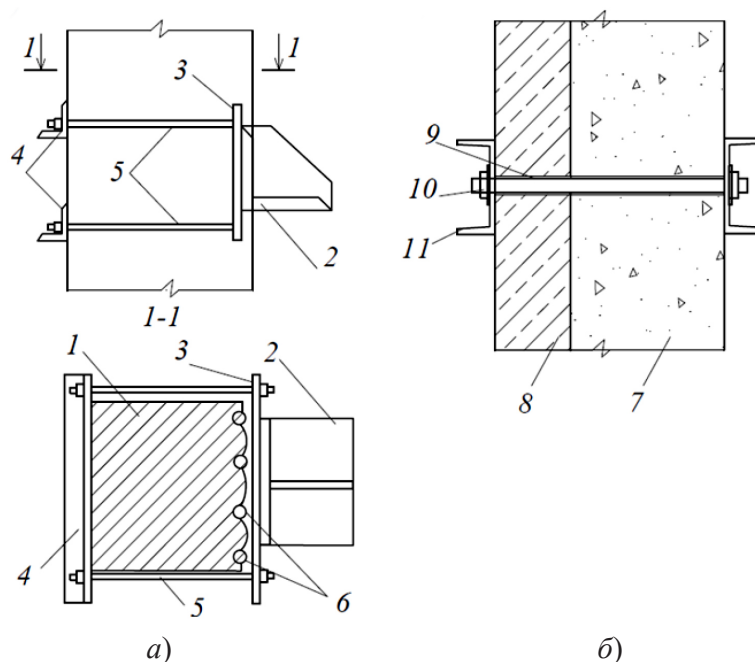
Усиление соединительных узлов стеновых панелей: *а* – крепление опорных столиков к колоннам; *б* – крепление самонесущих панелей к несущим; 1 – колонна; 2 – опорный столик; 3 – пластина; 4 – анкерный уголок; 5 – стяжные болты; 6 – оголенная арматура (после приварки зачеканивают раствором); 7 – самонесущая панель; 8 – несущая панель лестничной клетки; 9 – арматурный тяж в отверстии; 10 – шайба, гайка; 11 – швеллер
